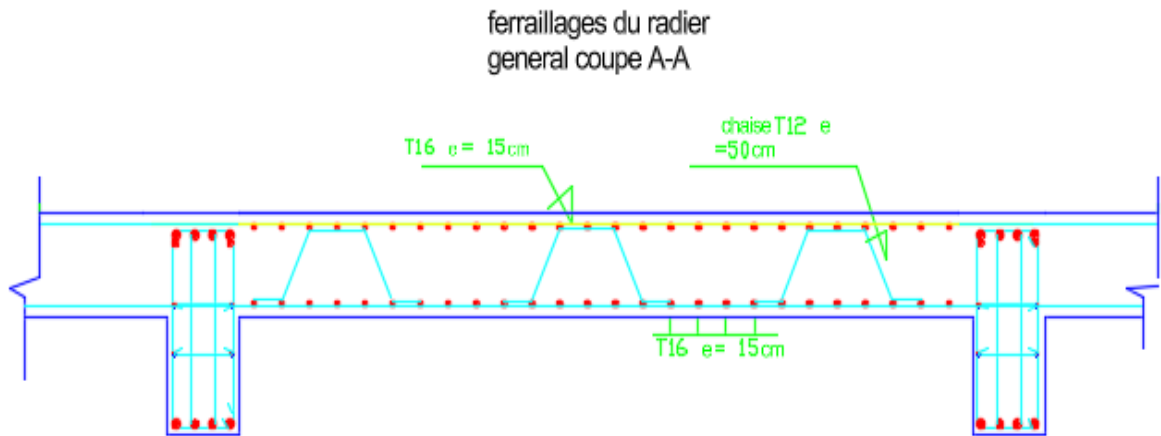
Schéma de ferraillage de la dalle du radier.
